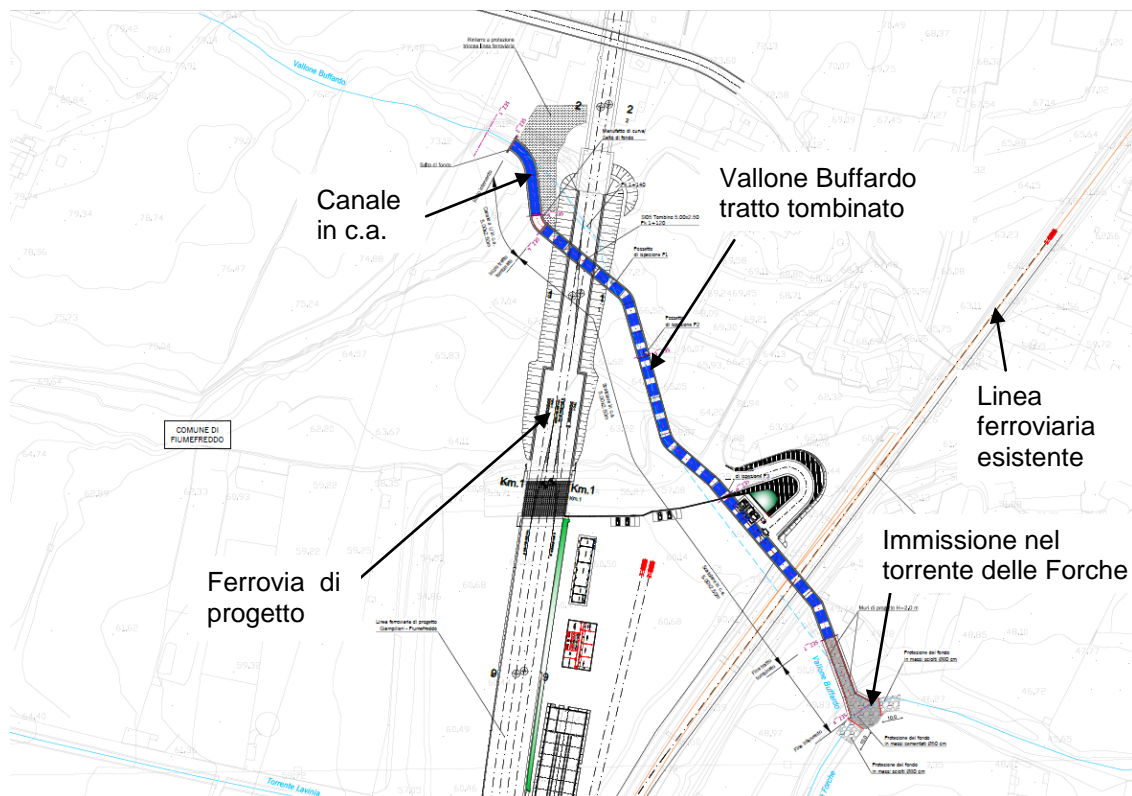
Stralcio planimetrico progetto Vallone Buffardo.
